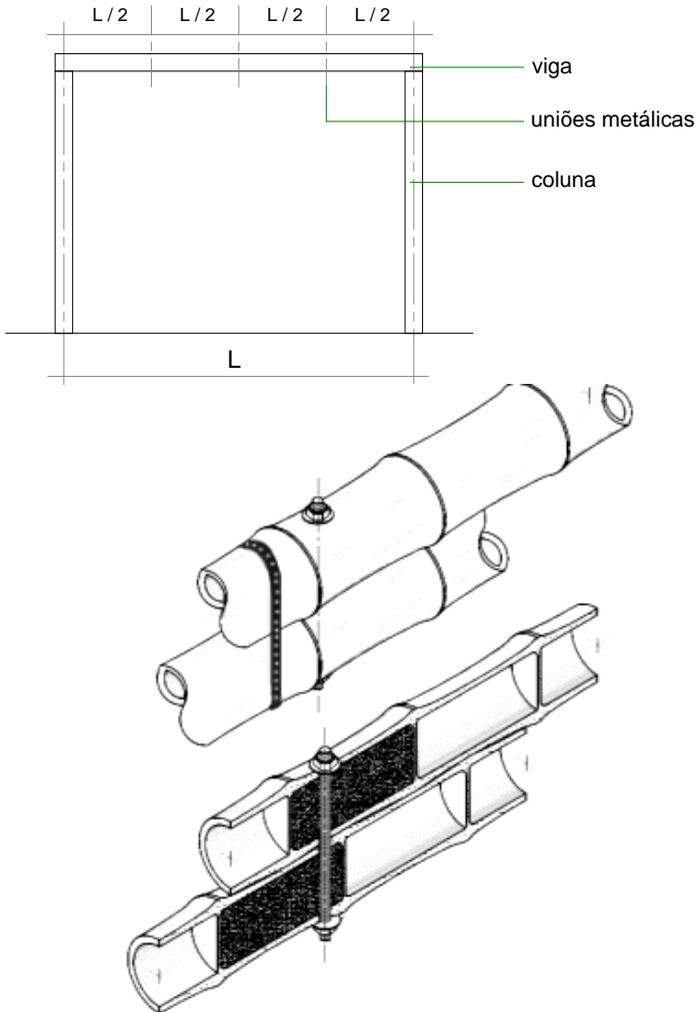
Detalhe união metálica reforçada de bambus em viga composta
